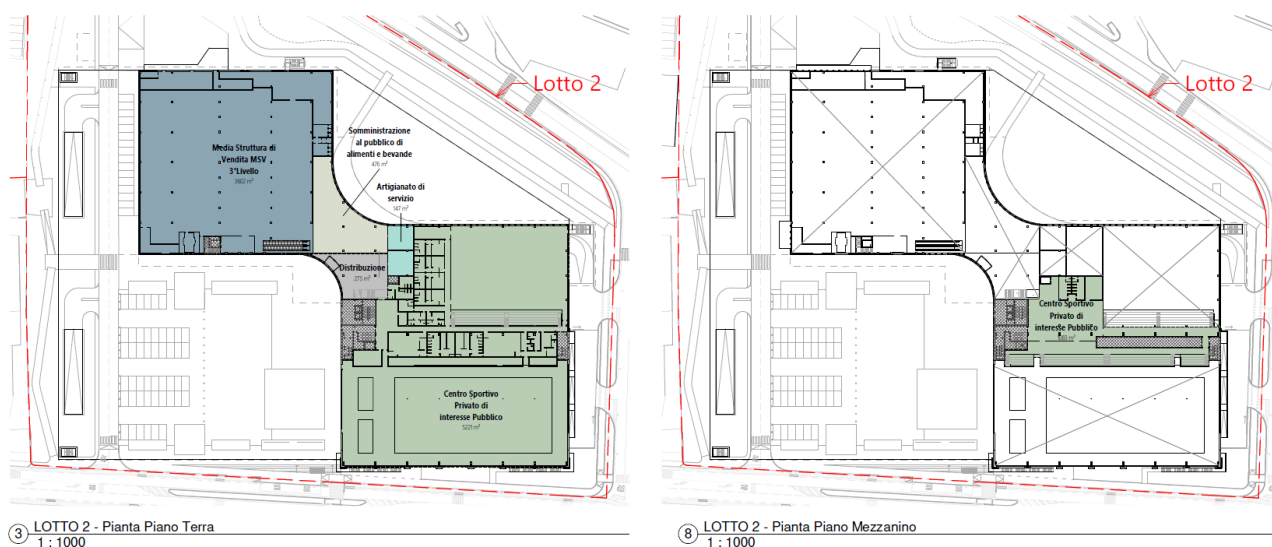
Stralcio piante del complesso multifunzionale - Piano terra e Piano mezzanino
